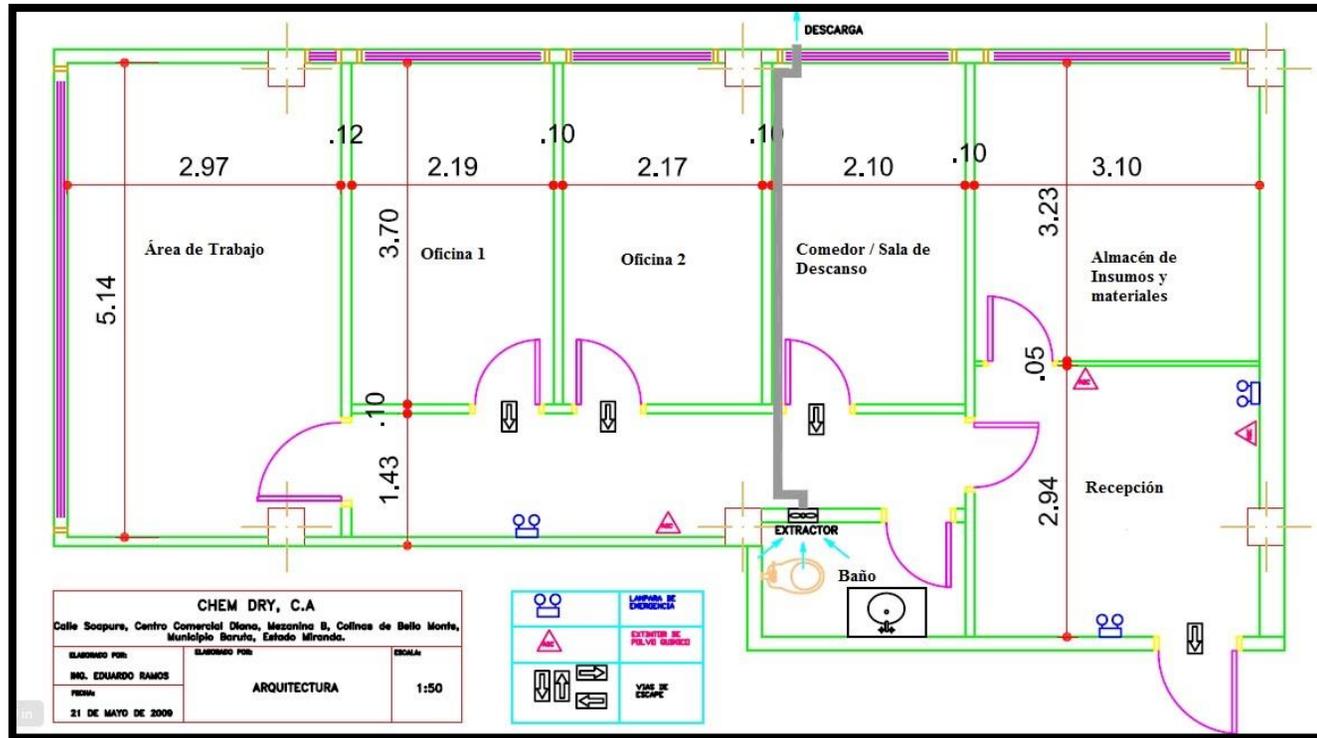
Plano Oficinas Chem-Dry, C.A.
